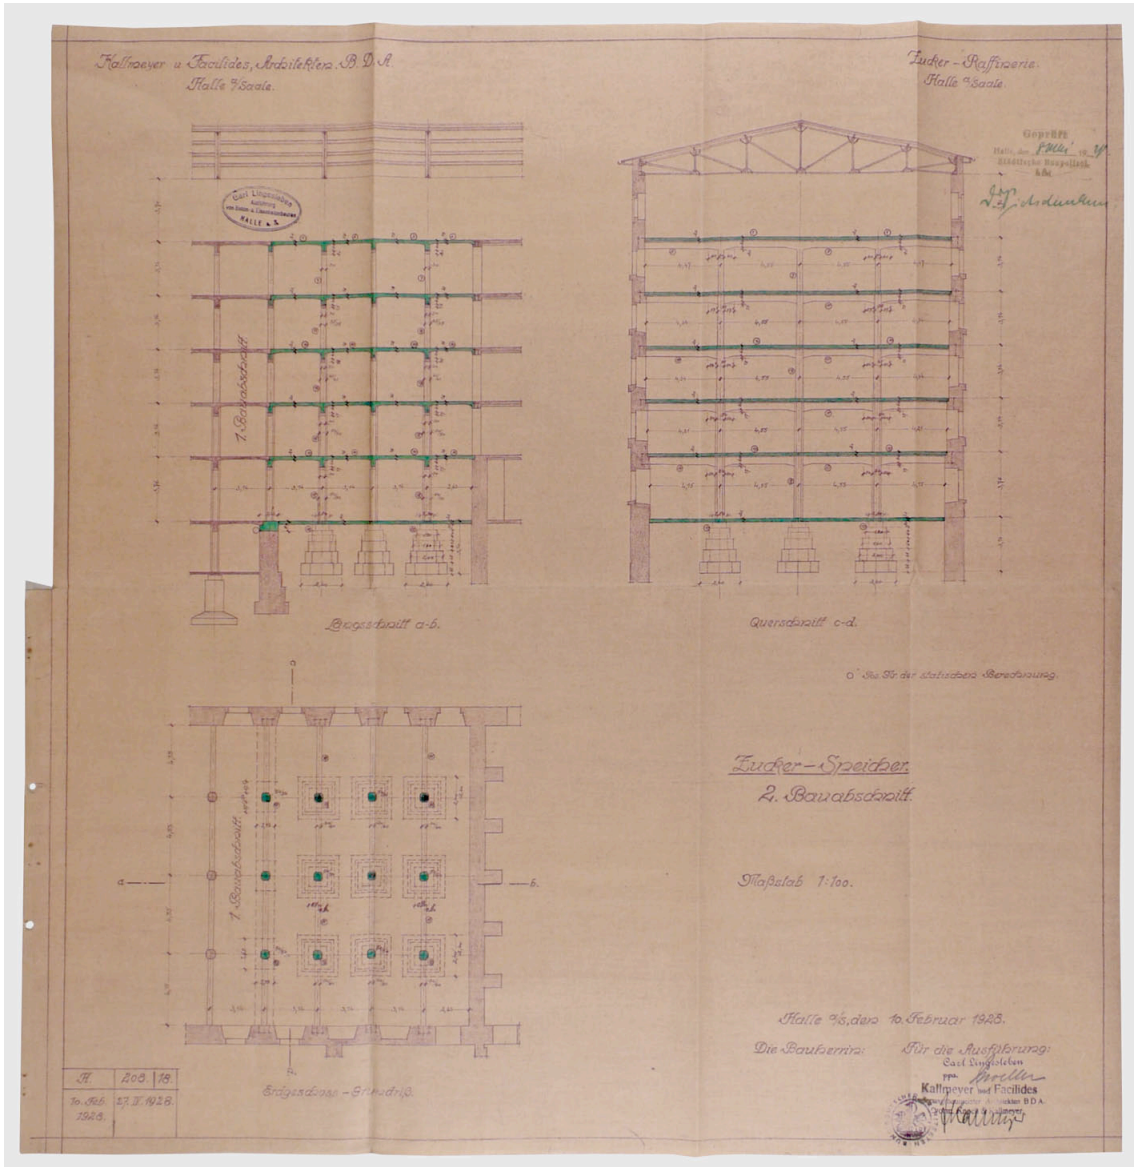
Zuckerspeicher in der Raffineriestraße 28 in Halle, Schnitte und Grundriss 2. Bauabschnitt, datiert 10. Februar 1928.
